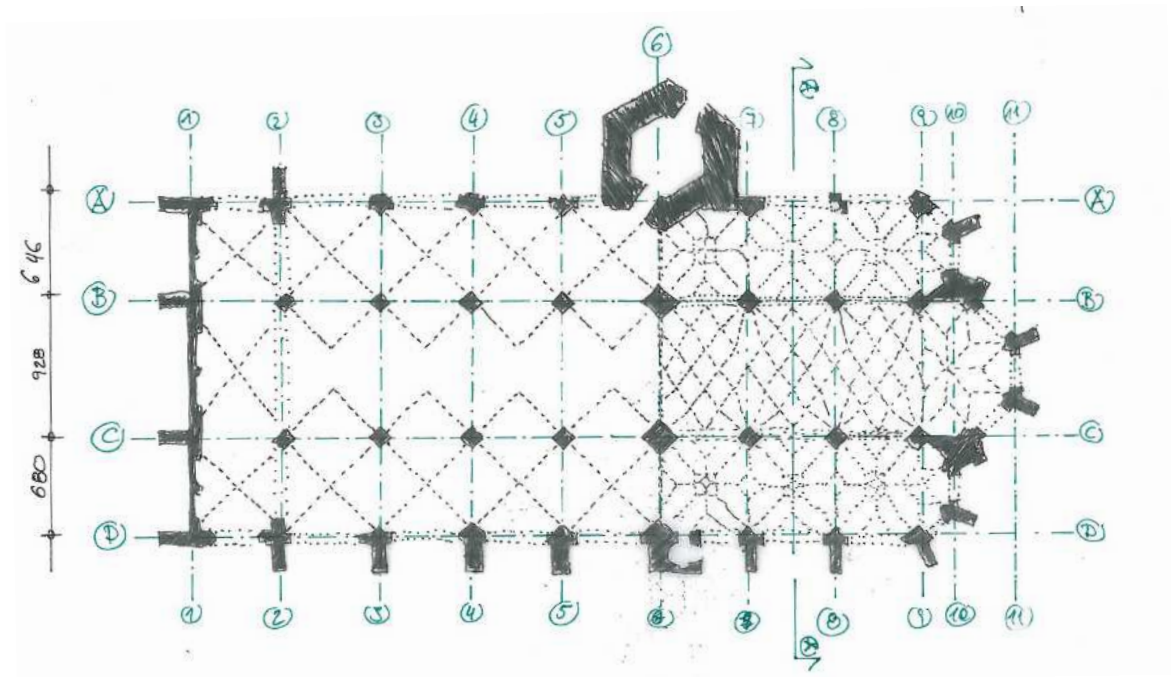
Steyr, Stadtpfarrkirche, Grundrisskizze; Darstellung der wesentlichen Trag- und Gewölbestruktur, sowie Achseneinteilung
